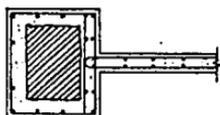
Muro de relleno unido a una columna por encamisado.
